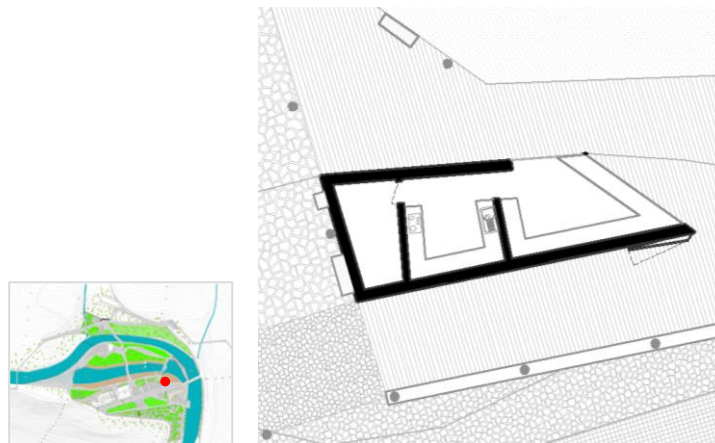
Planta do bar da praia; Fonte: Autoria Própria.
